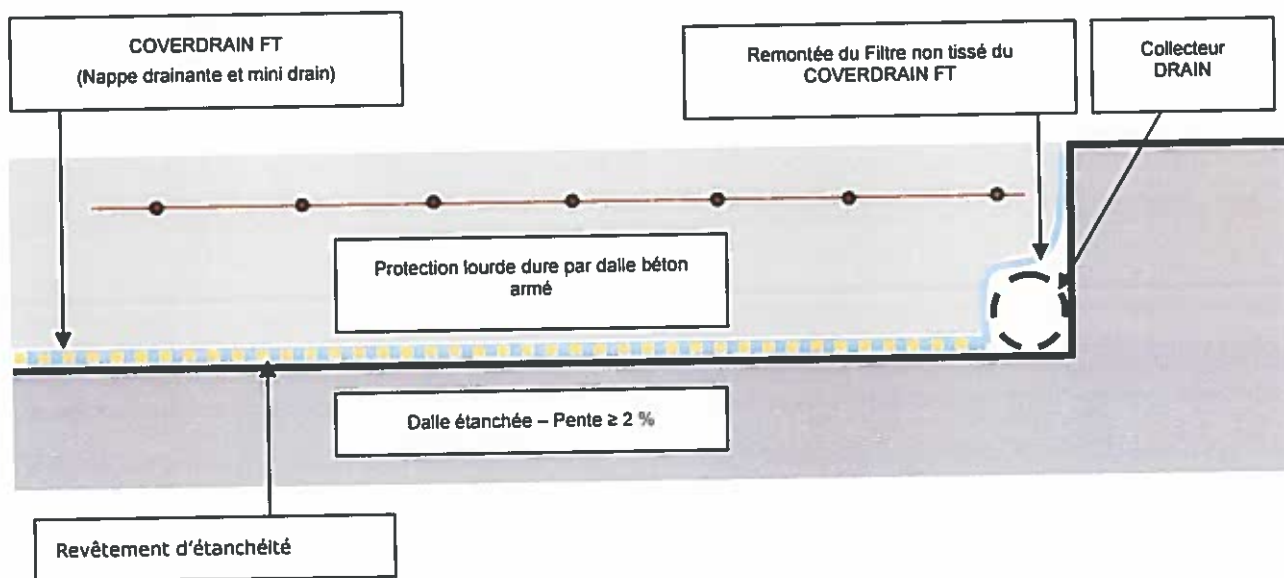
Connexion au drain collecteur – exemple avec une protection lourde dure en dalle béton armée
